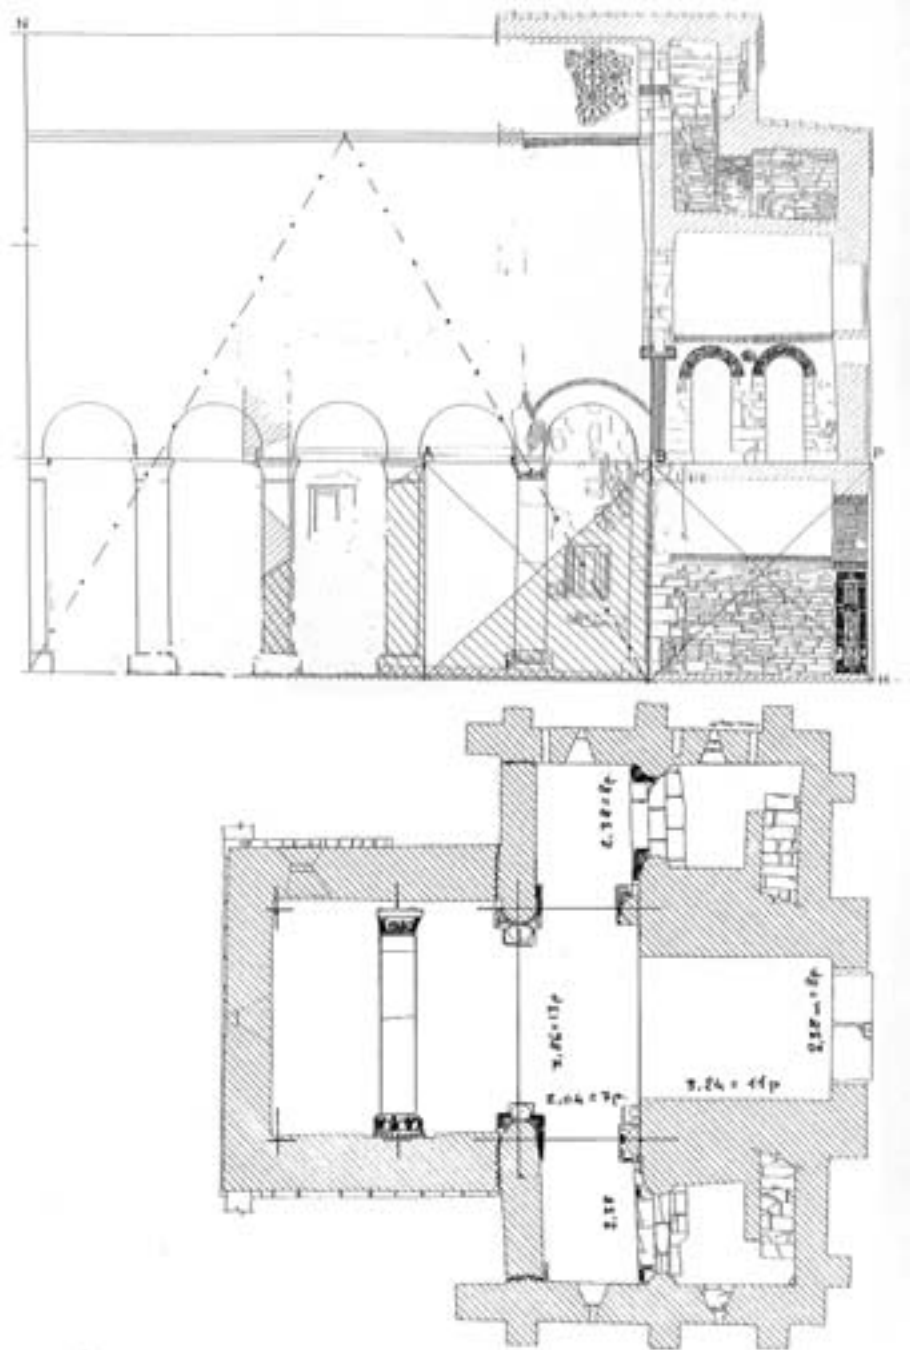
San Miguel de Liño, alzado y planta de L. Arias Páramo. Sobre el alzado la geometría del triángulo equilátero. Sobre la planta las medidas y la columna.
